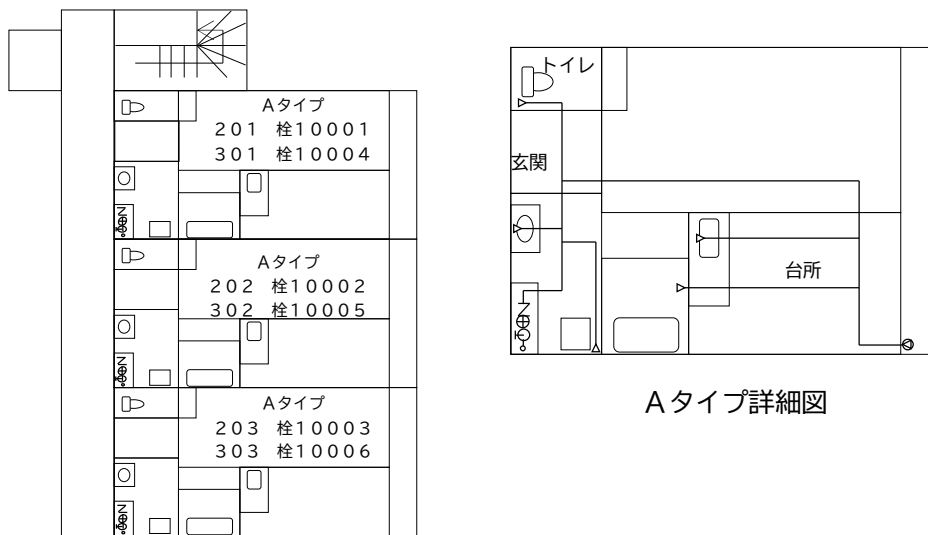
同一タイプの部屋がある場合の平面図の記入例
